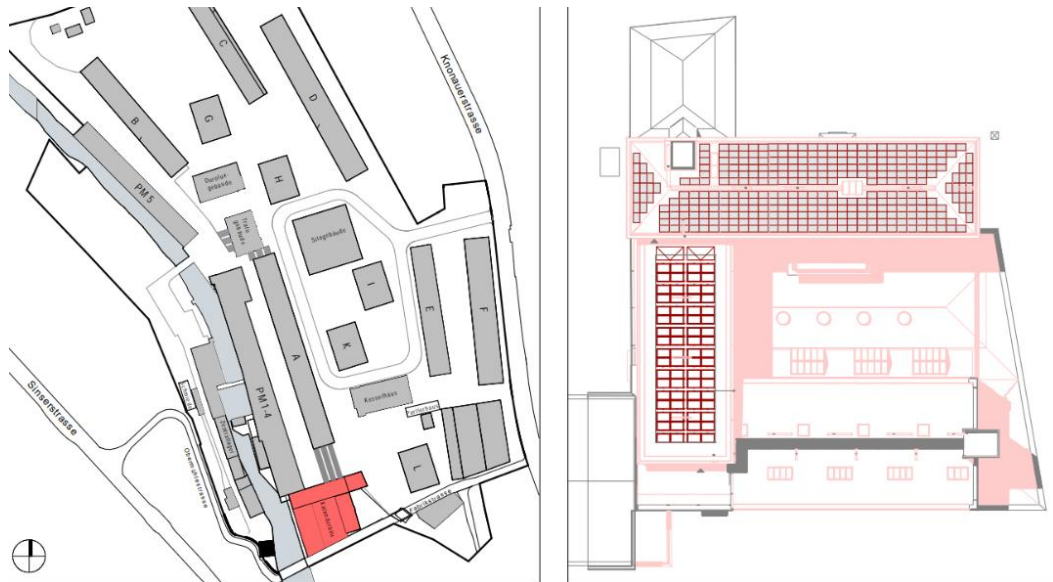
Grundriss Areal mit Gebäude Kalendarbau
